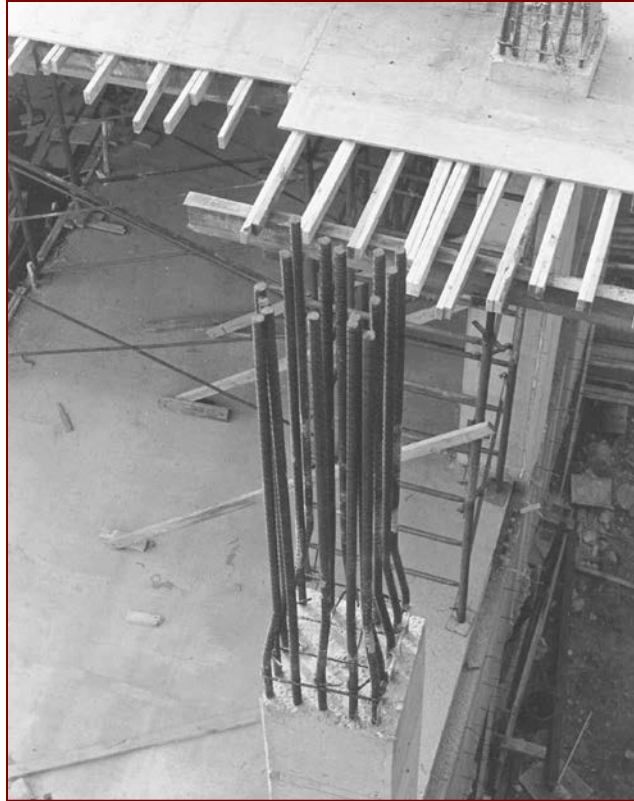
Columna con aros en construcción. (Fotografía cortesía de J. G. MacGregor)
